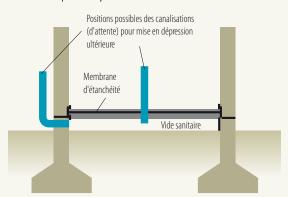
Membrane d'étanchéité : dalle sur vide sanitaire Mise en place d'un système d'attente
